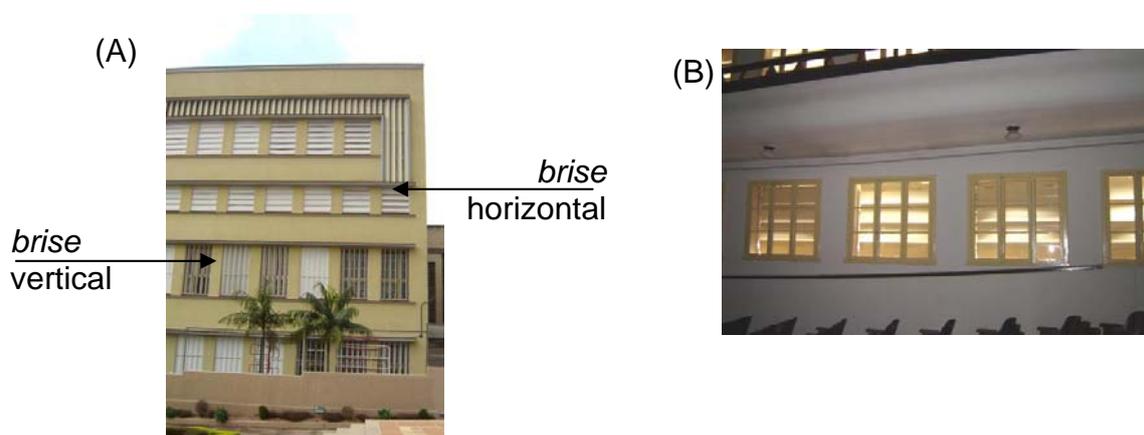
(A) vista externa da fachada Oeste (B) vista interna do auditório
